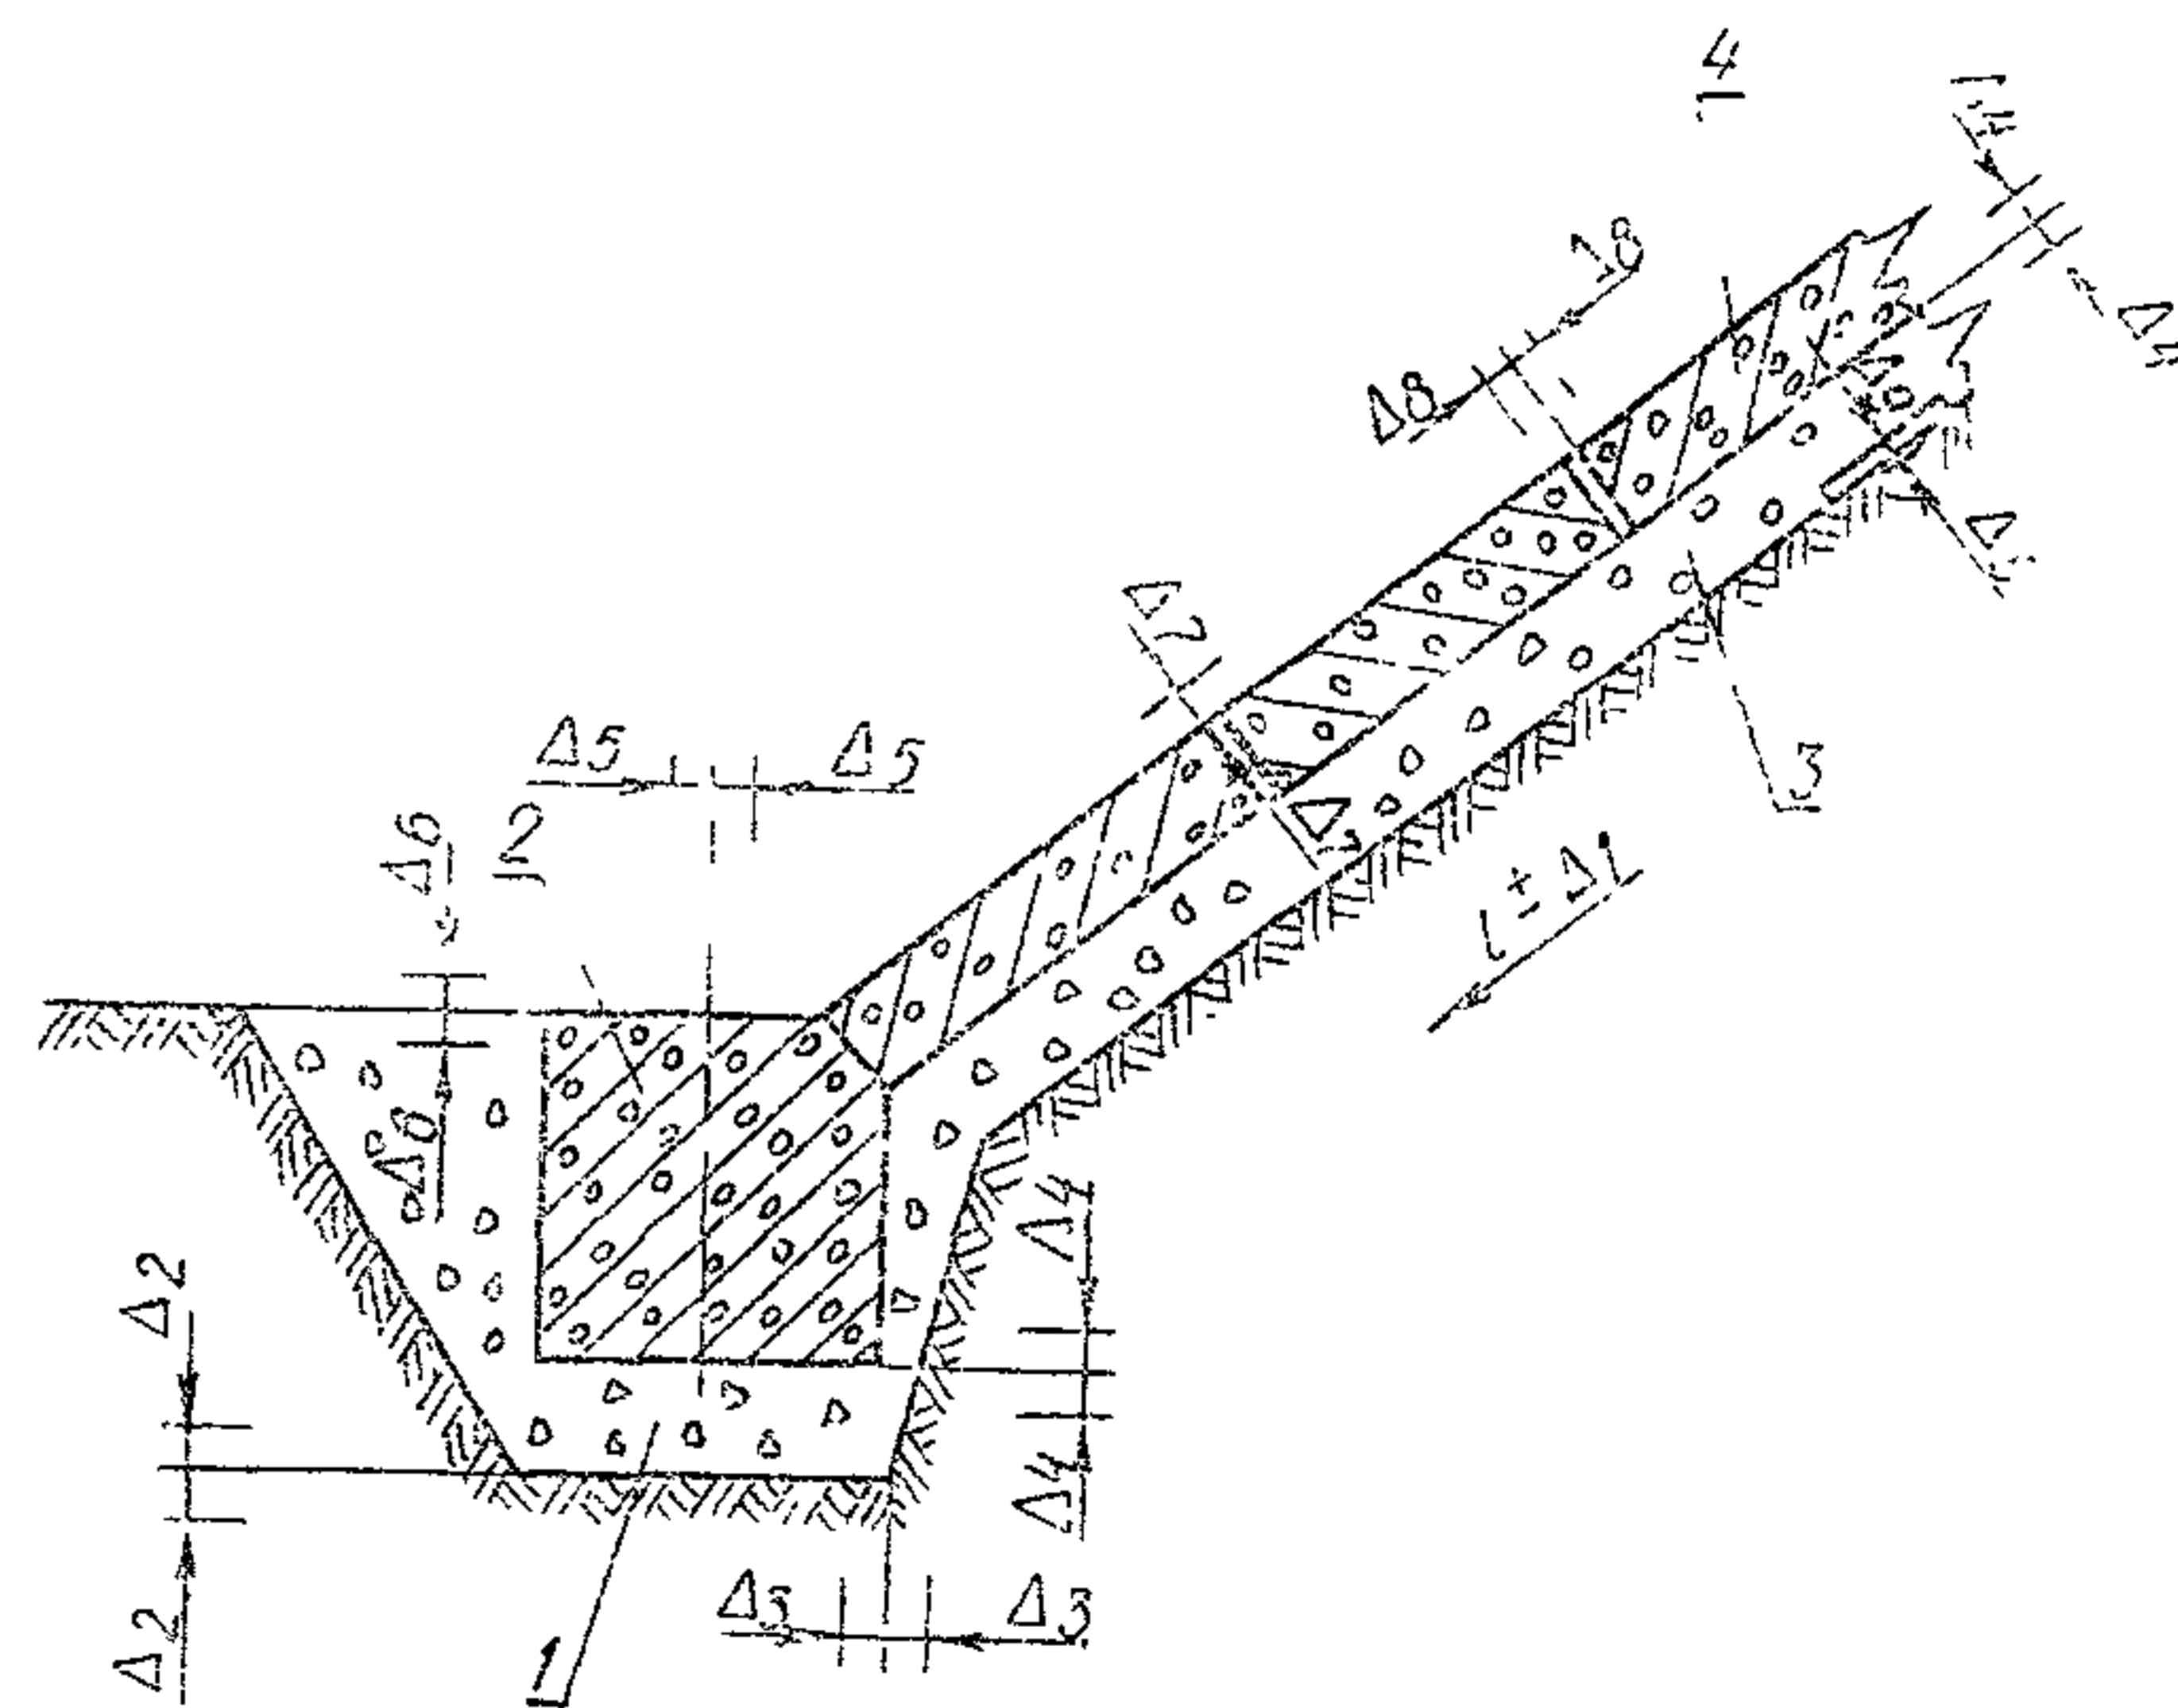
Схема укрепления откоса насыпи железобетонными плитами:
